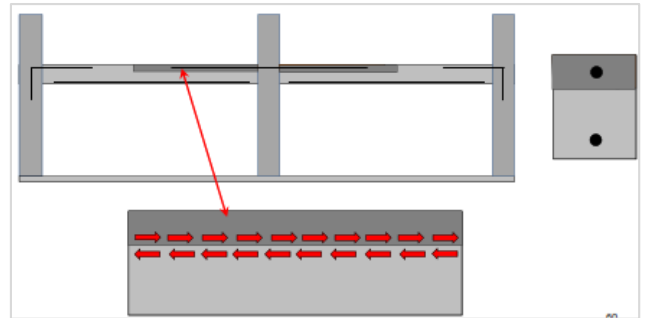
Adherencia entre concreto nuevo y viejo.
